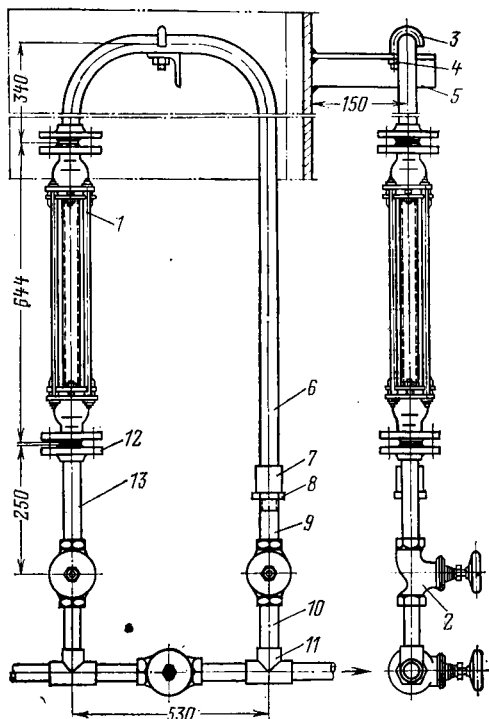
Установка ротаметра типа РС-7 с условным диаметром 50 мм на металлической стенке.
